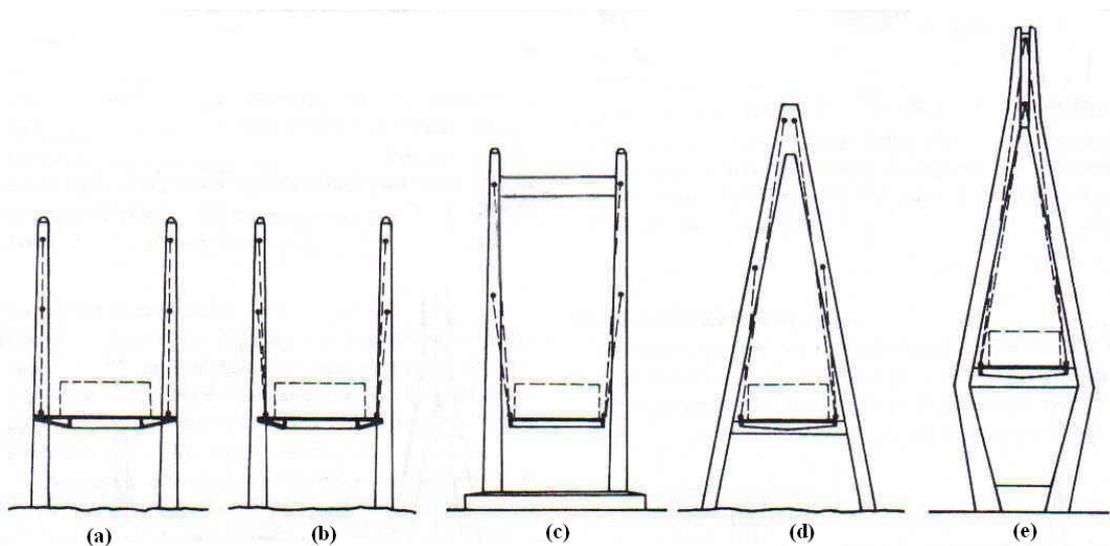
Diseño de los pilones debido a la forma de la estructura
